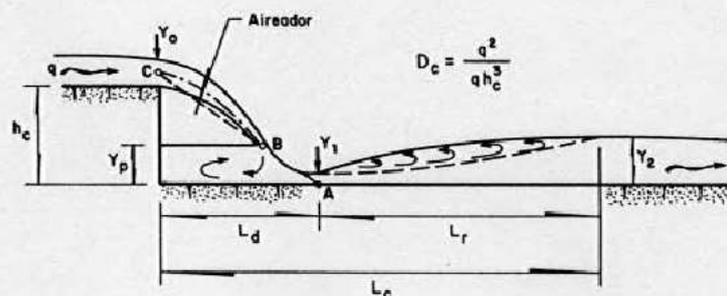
Geometría del flujo en las estructuras de caída [5]
